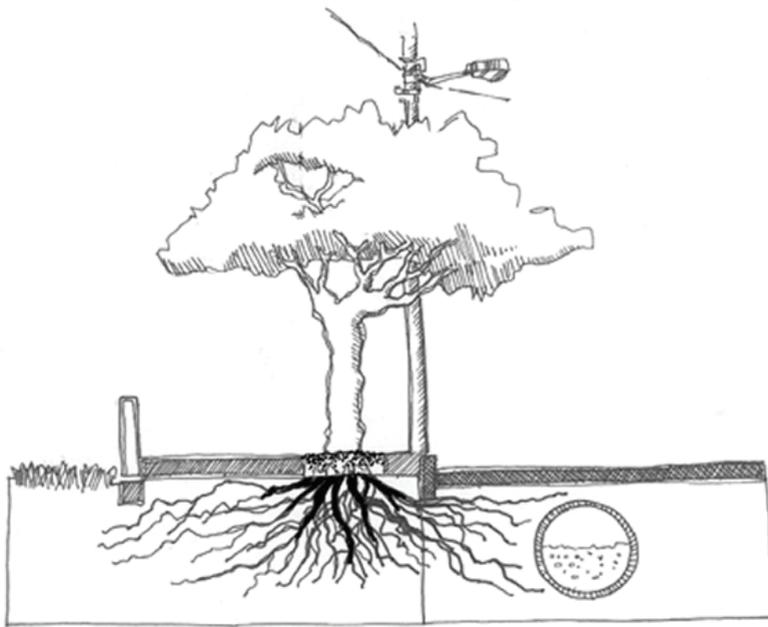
Comportamento do crescimento da planta em relação a calçadas, postes e redes de esgoto
